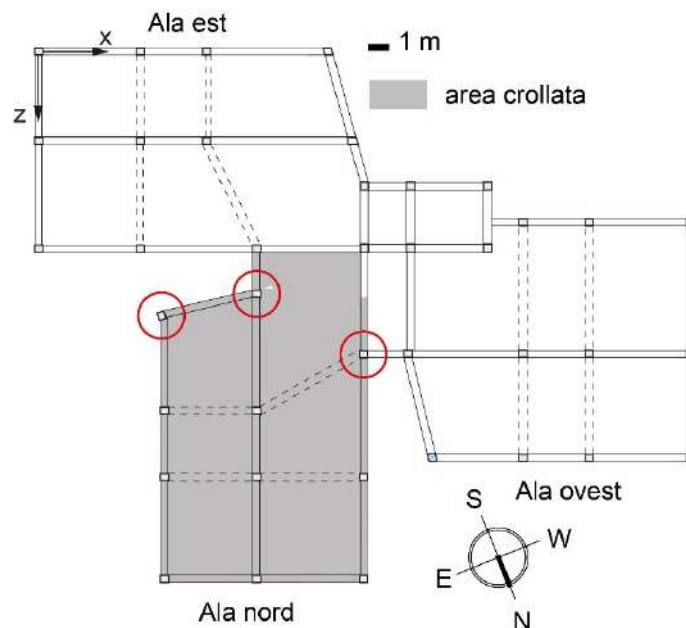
Vista in pianta dell'edificio con indicazione della porzione di struttura crollata. Le colonne crollate sull'intera lunghezza sono indicate con un cerchio rosso
